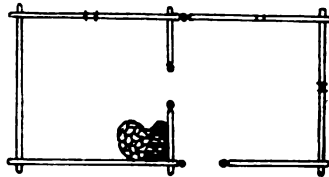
Jassew bei Kobylnit. Grundriß zu Abb. 2.
